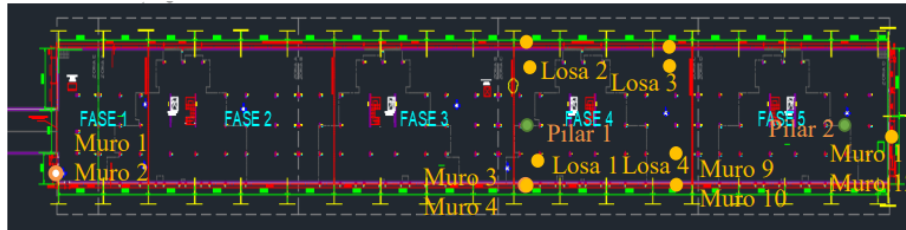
Detalle en planta de las zonas monitorizadas en el aparcamiento.
